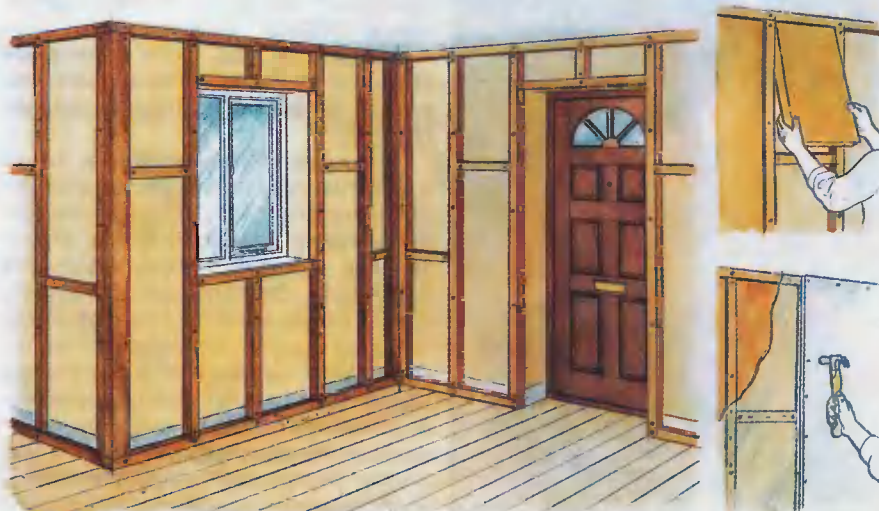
Теплоизоляция стен. Вдоль каждой из наружных стен монтируют каркас для крепления сухой штукатурки, устанавливая теплоизоляцию, а затем крепят гипсокартонные листы
